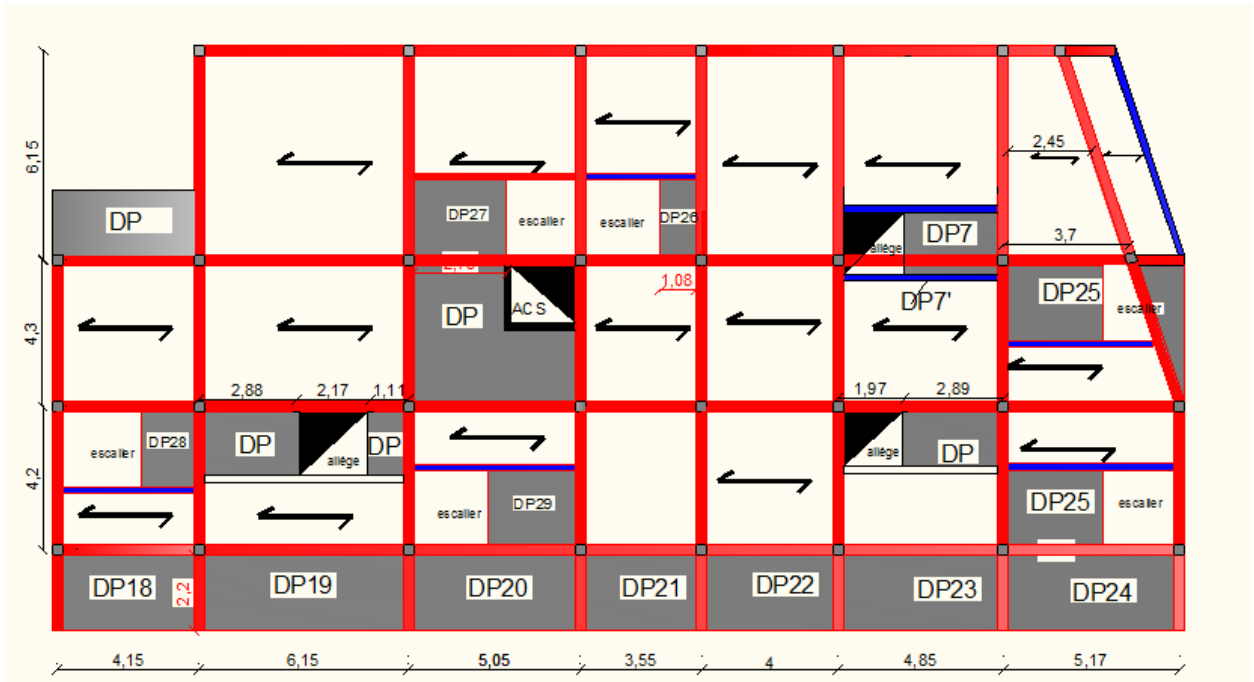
Disposition des poutrelles (deuxième niveau duplexe).
